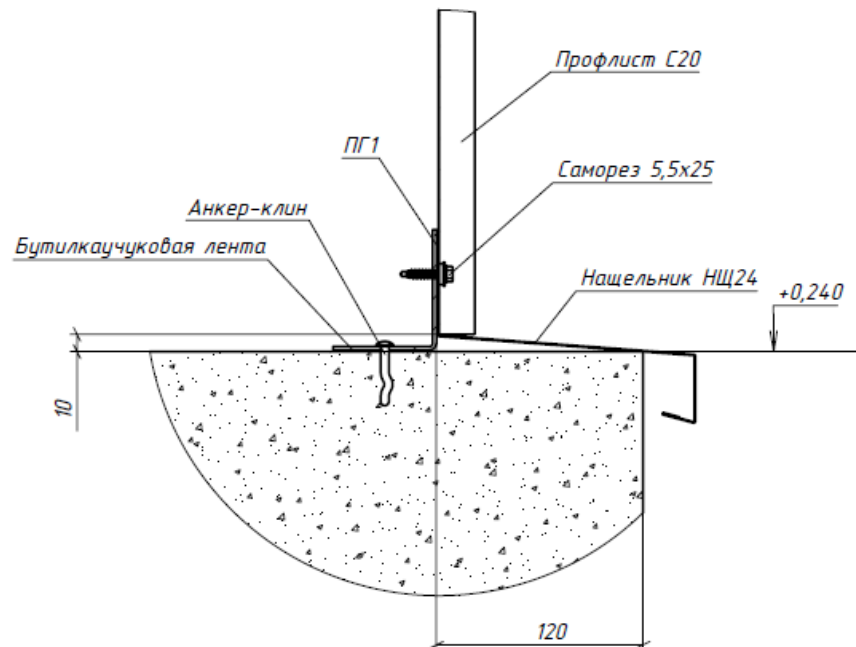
Узел крепления стенового профлиста С20 к м/конструкциям здания
